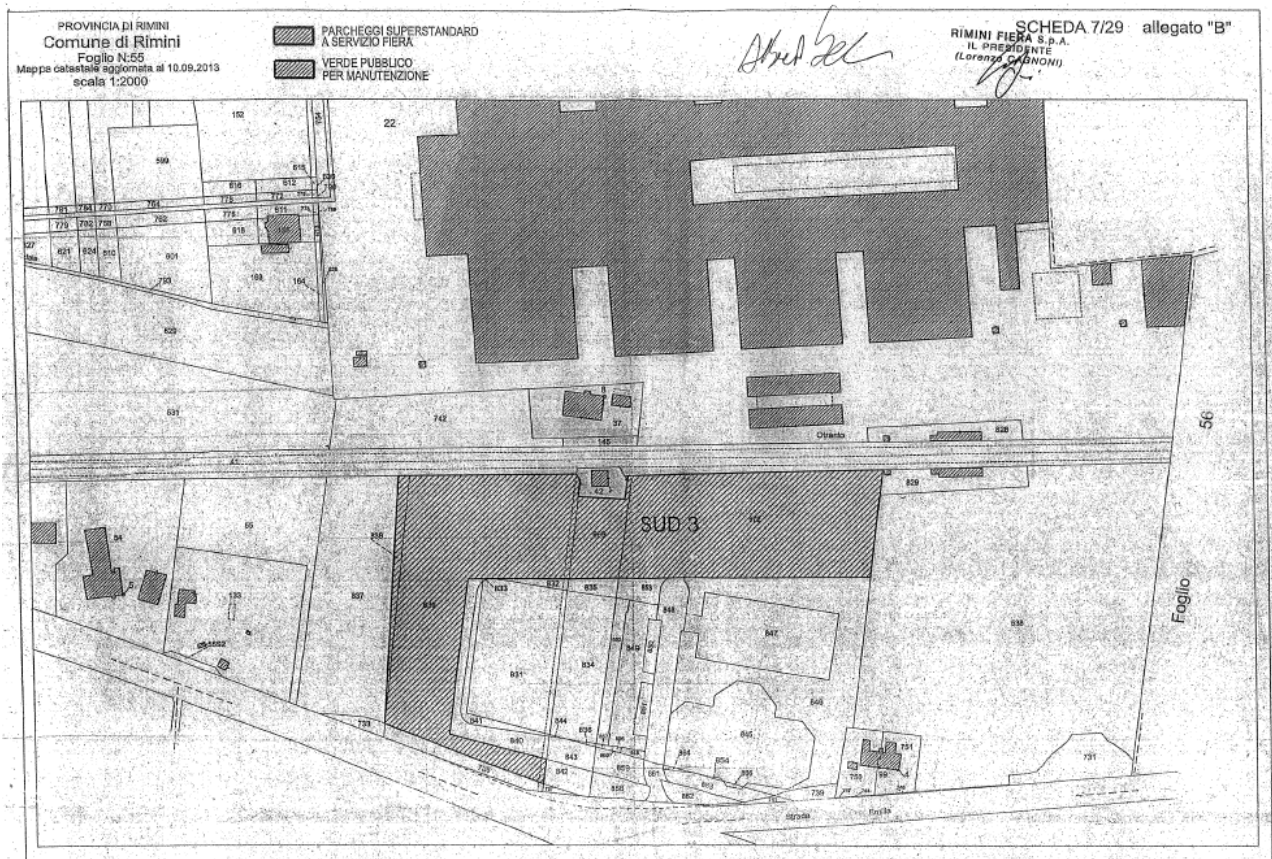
a – estratto della planimetria del parcheggio SUD 3 oggetto di convenzione 2016
